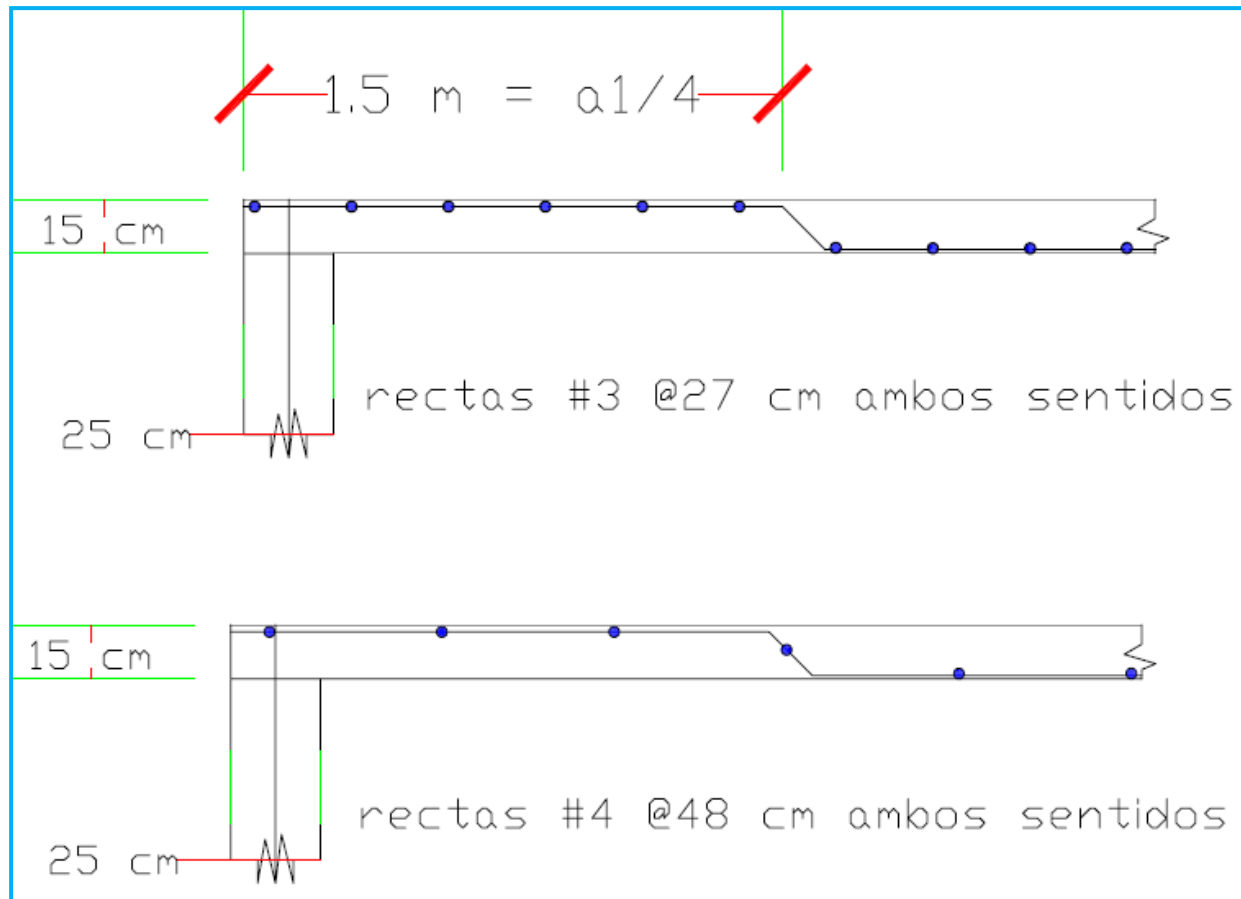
Croquis de los armados de la losa con acero mínimo para varillas del # 3 y # 4, para el lado cortó
